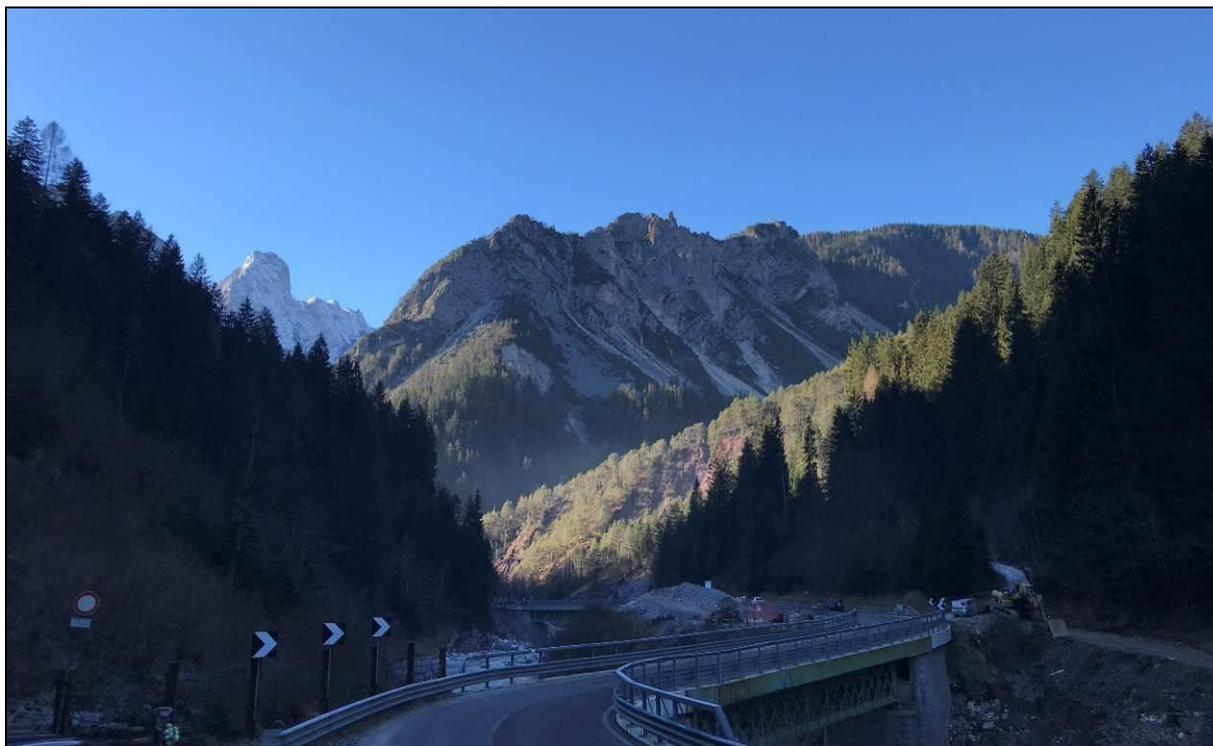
Vista della Valle del Piave nel tratto d'intervento in direzione Sud.
